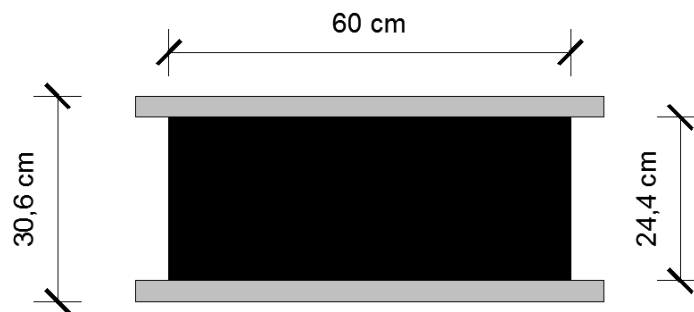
Dimensiones del aislador para el edificio de 5 pisos
